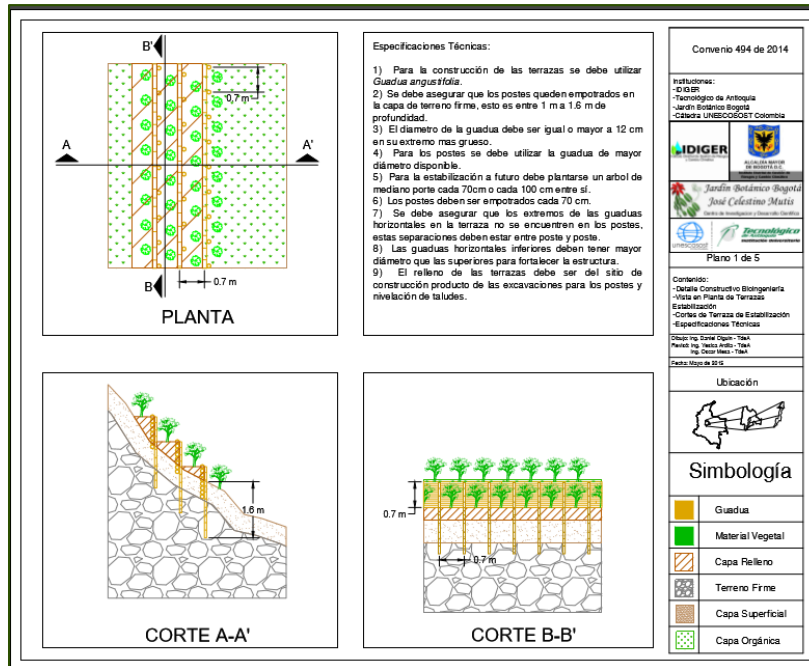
Plano Filtro Vivo Cordillera Sur
